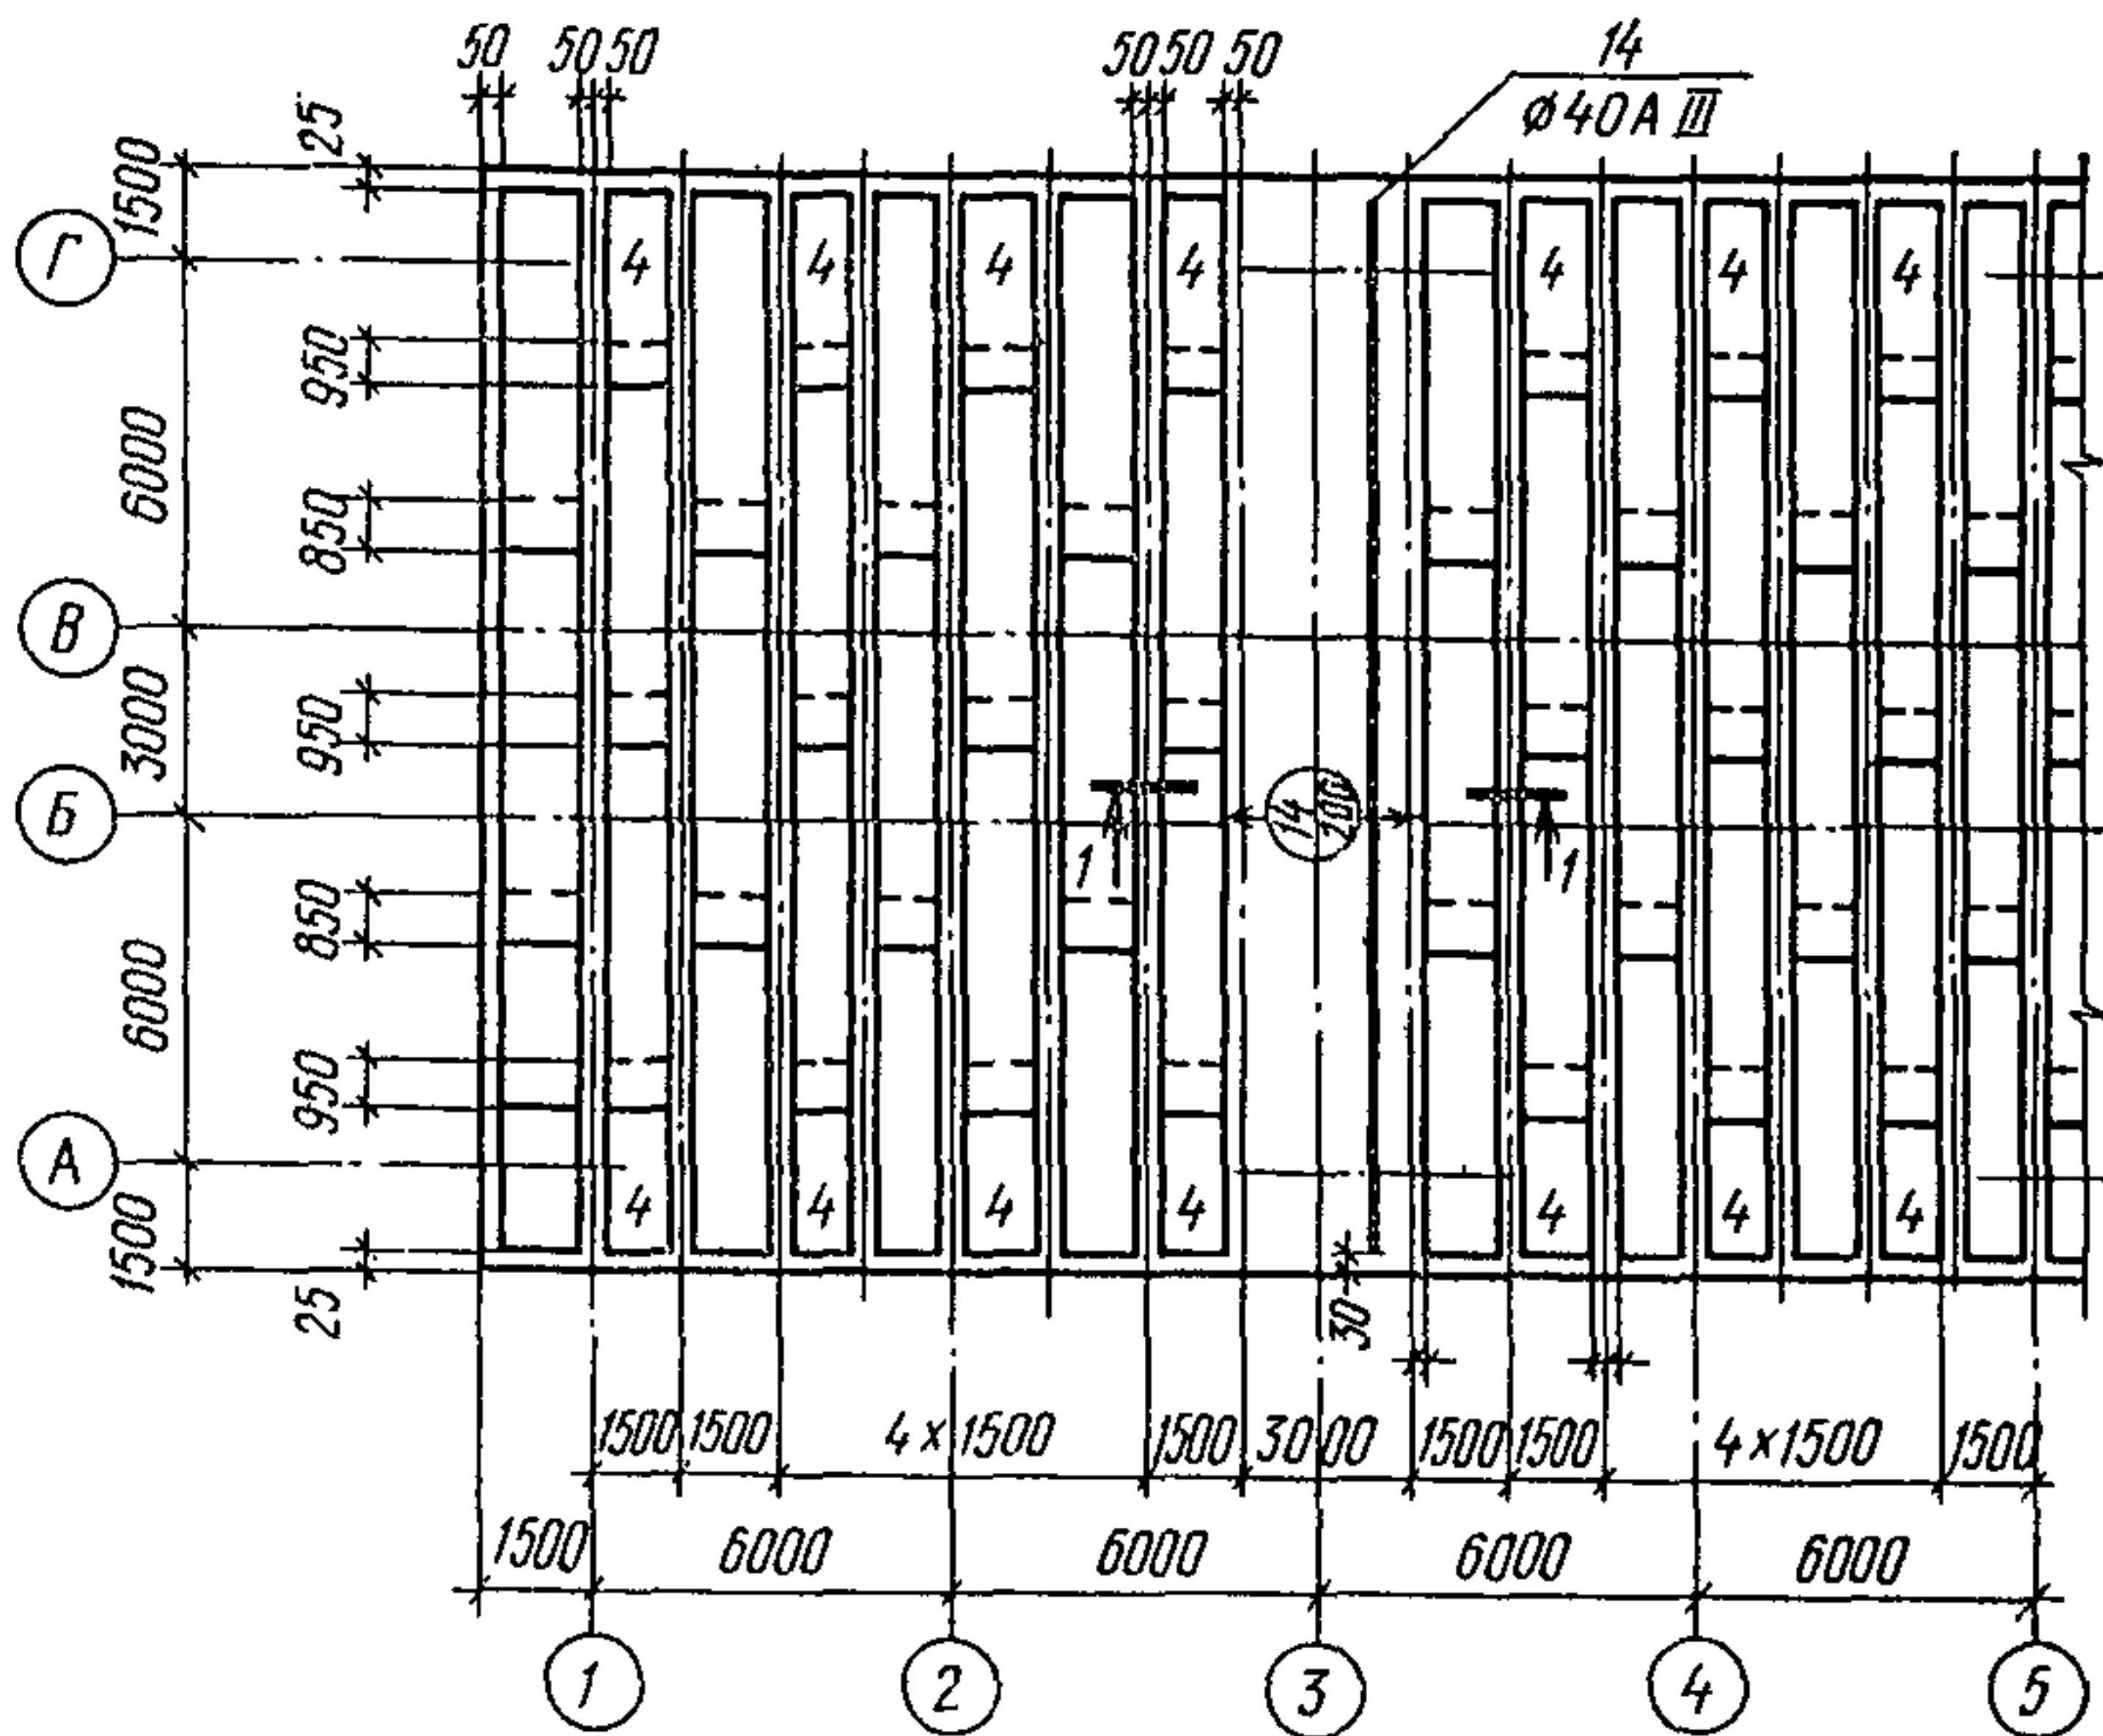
План раскладки унифицированных сеток и арматуры первого слоя нижней зоны
